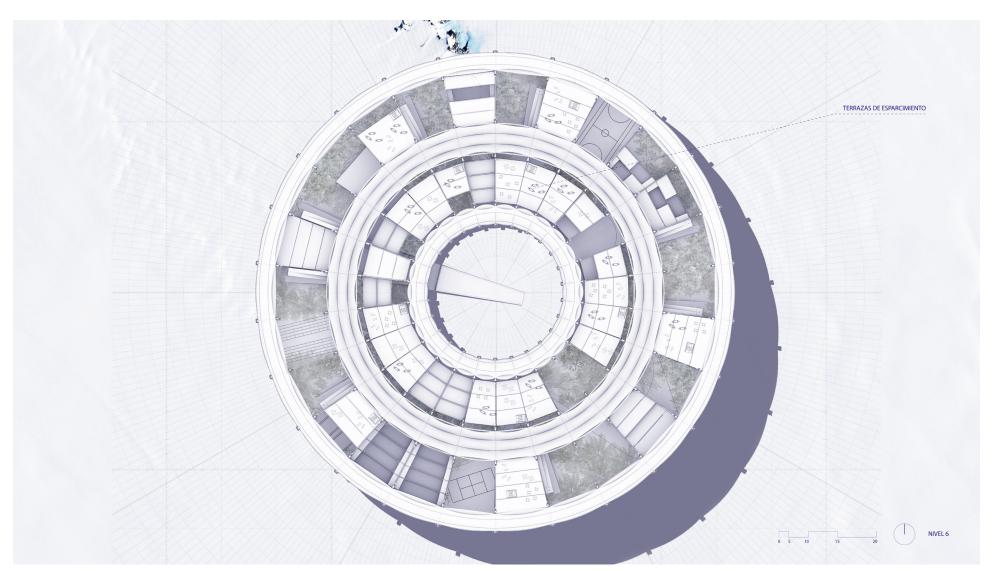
Planta nivel 6, Elaboración propia, 2021.
